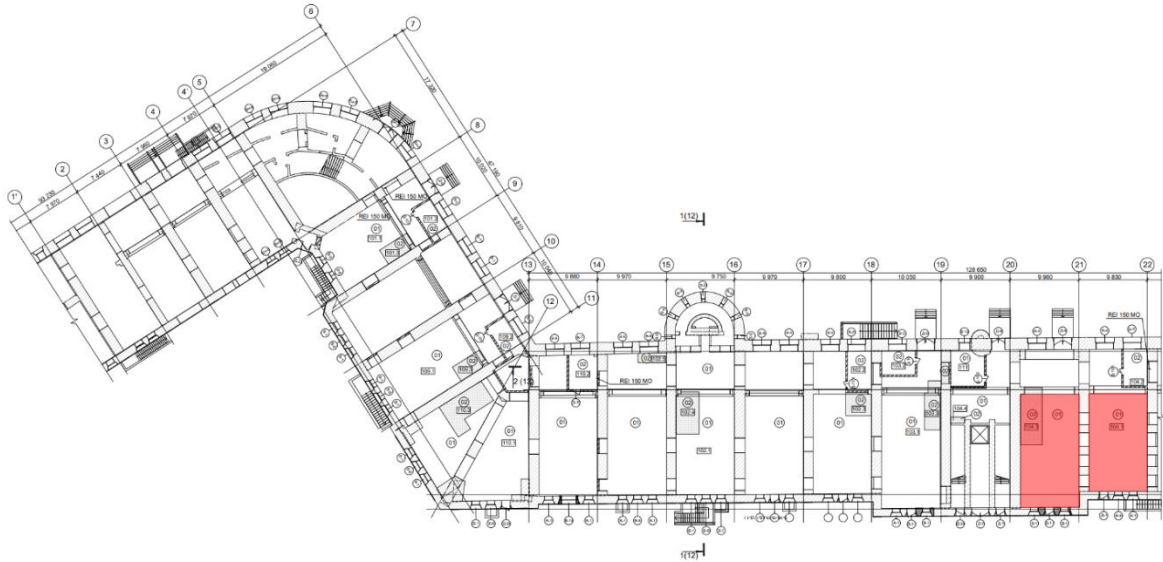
Обрана ділянка проєктування на фрагменті плану будівлі 1-го поверху.
